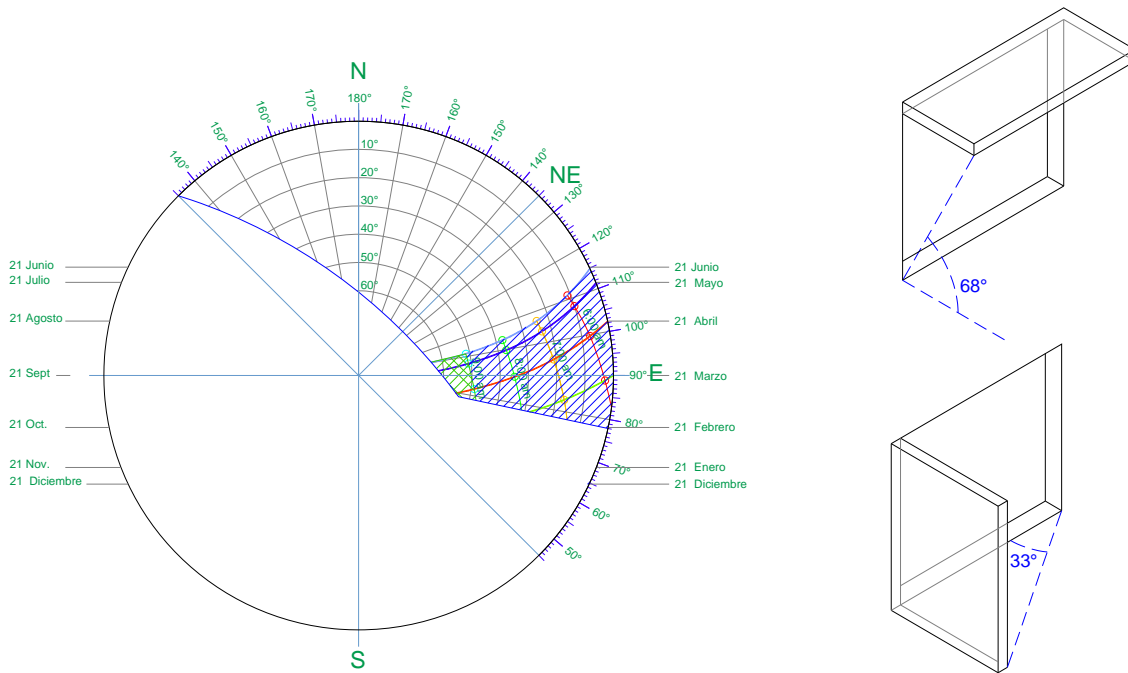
Protección solar, alero y partesol en Fachada noreste
